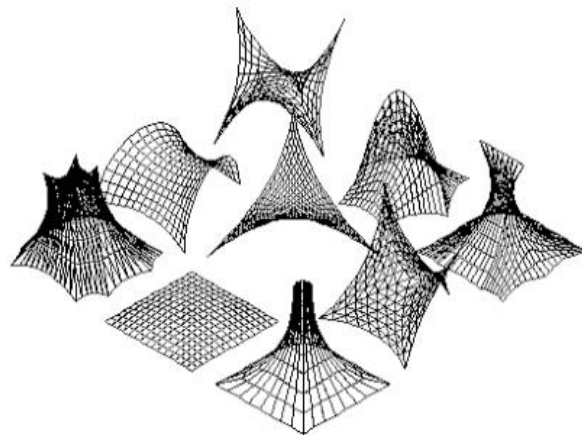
Ejemplos de geometrías alcanzables para la cubierta textil⁶
